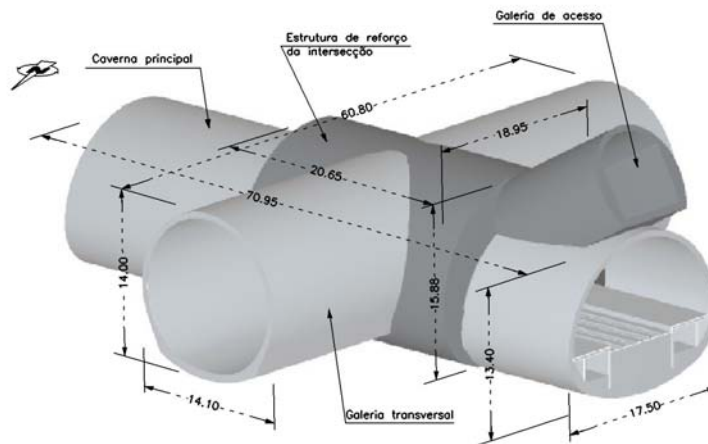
Esquema tridimensional das cavernas da estação do Bolhão
